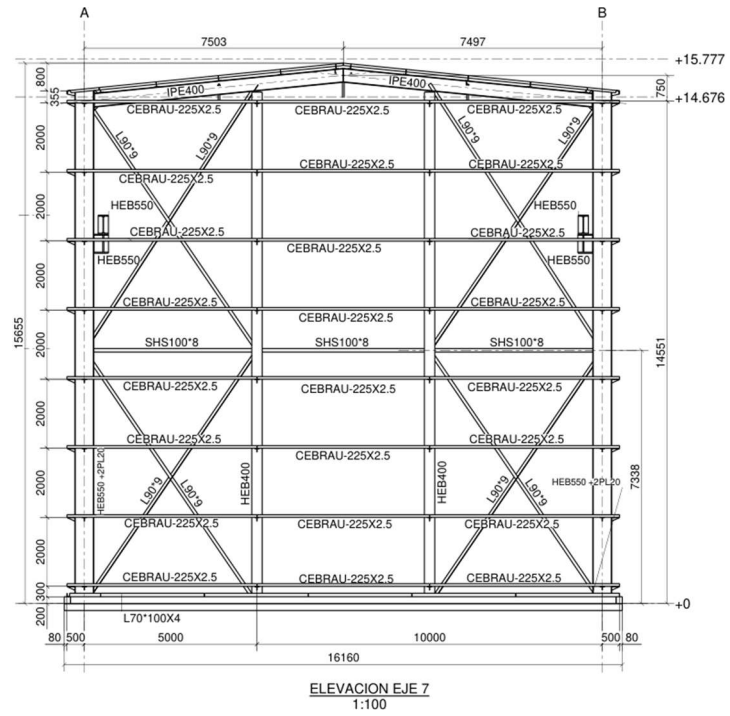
Elevación eje 7 Nave Metálica grupo 7.
